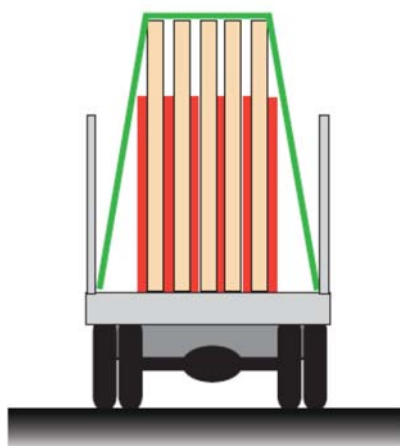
Sistemi di montanti ad innesto per disposizione simmetrica degli elementi prefabbricati
